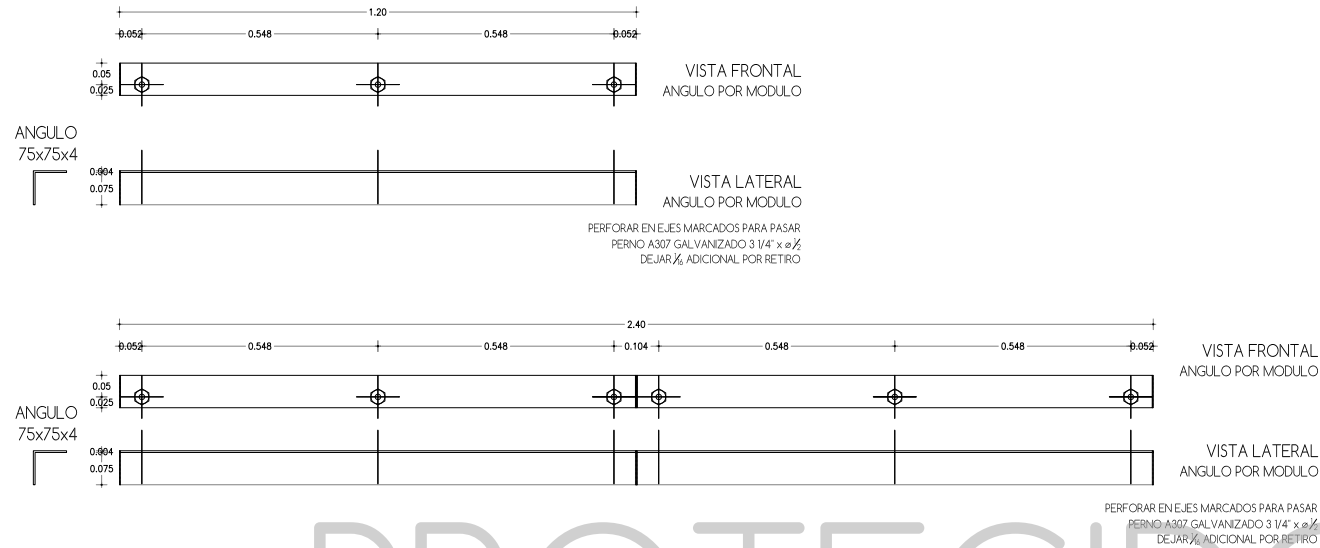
Detalle de junta horizontal: pieza ángulo para uno y dos módulos
